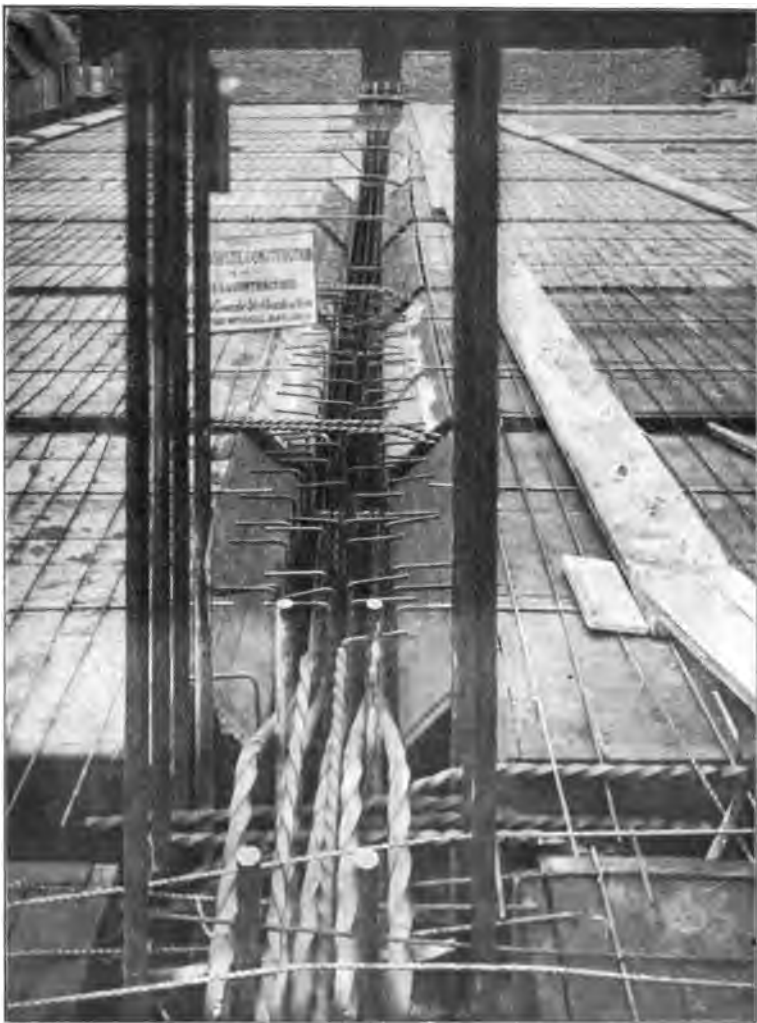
Brückenarmatur bei der Ferro-Concrete Co.-Chicago.
